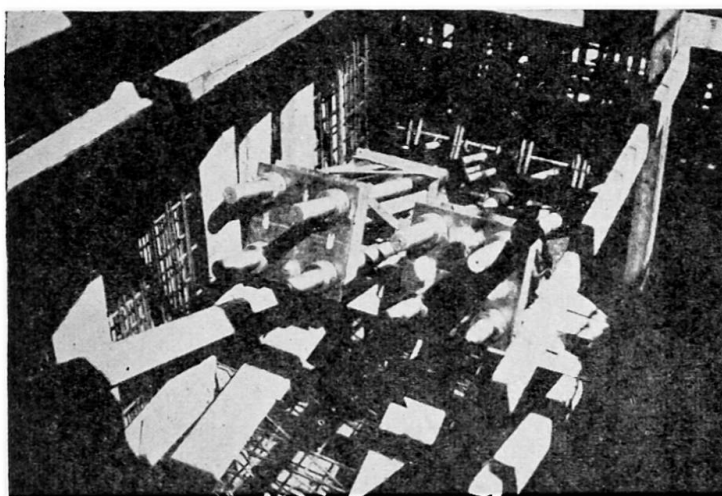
Ancrages.—Mise en place dans le ferrailage d'un voile. On distingue les gabarits métalliques percés d'un trou central et permettant la mise en place correcte de l'ancrage par rapport à un fil métallique matérialisant l'axe du câble
